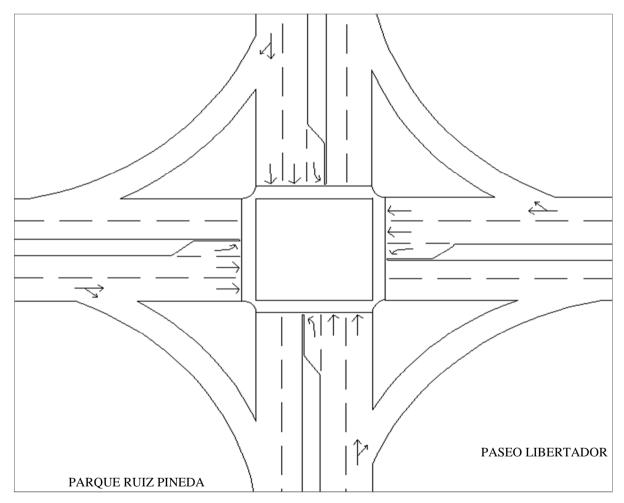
Vista en planta de la propuesta en la redoma Puerto Ordaz.
